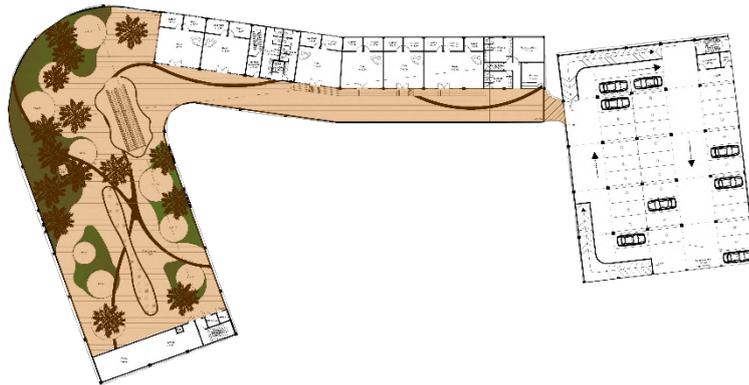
Sirkulasi Dalam Bangunan (Lantai 1)
